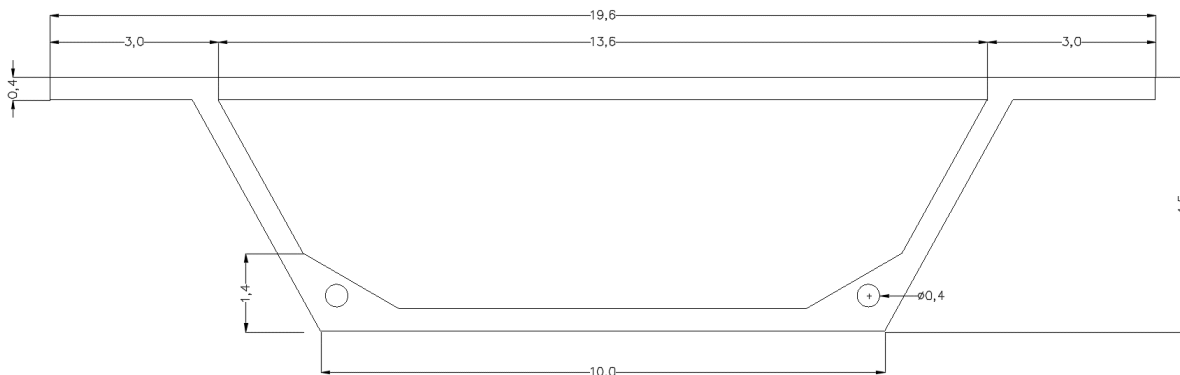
Corte transversal de la sección de la viga cajón del puente.
